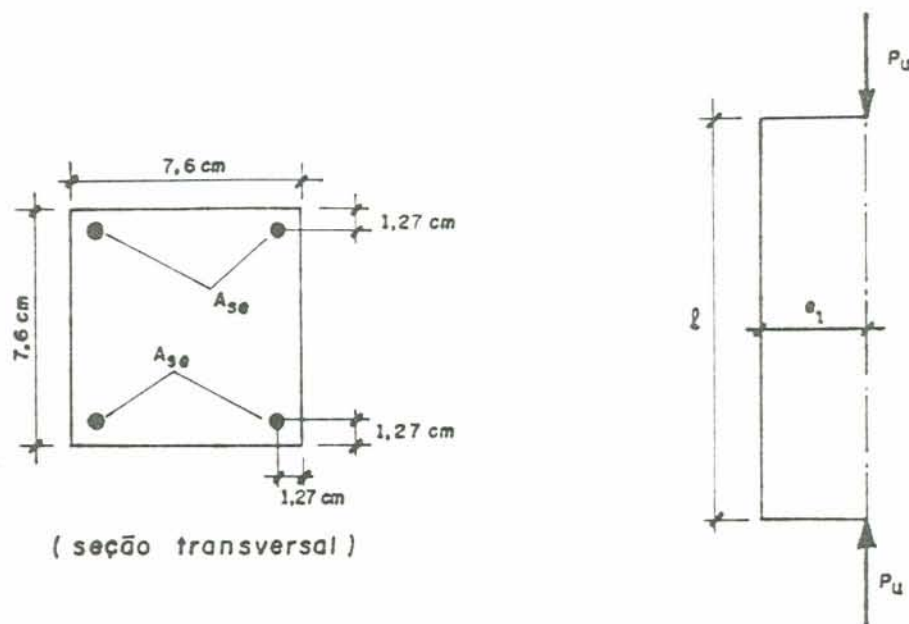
Geometria e carregamento dos pilares.
